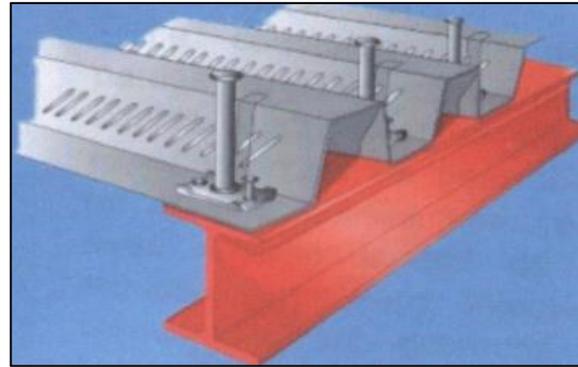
schéma latéral d'assemblage (poutre – plancher)
